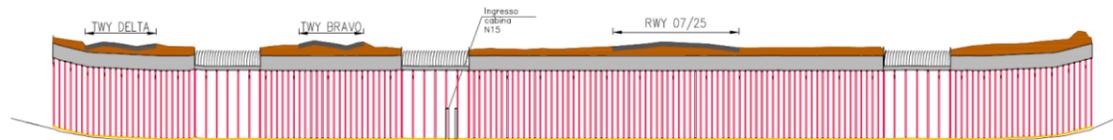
Profilo longitudinale sottopasso esistente (scala deformata 1/10)
